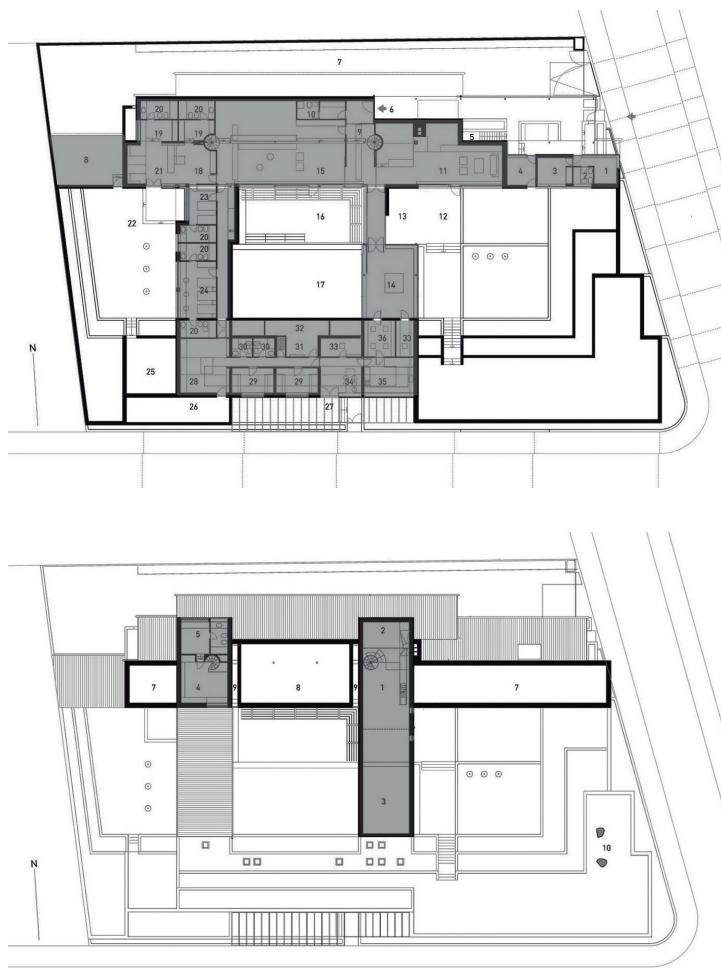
Casa Huarte, planimetría. Planta baja y planta alta. Estado final de obra (1966). Dibujos: Pablo Olalquiaga.
